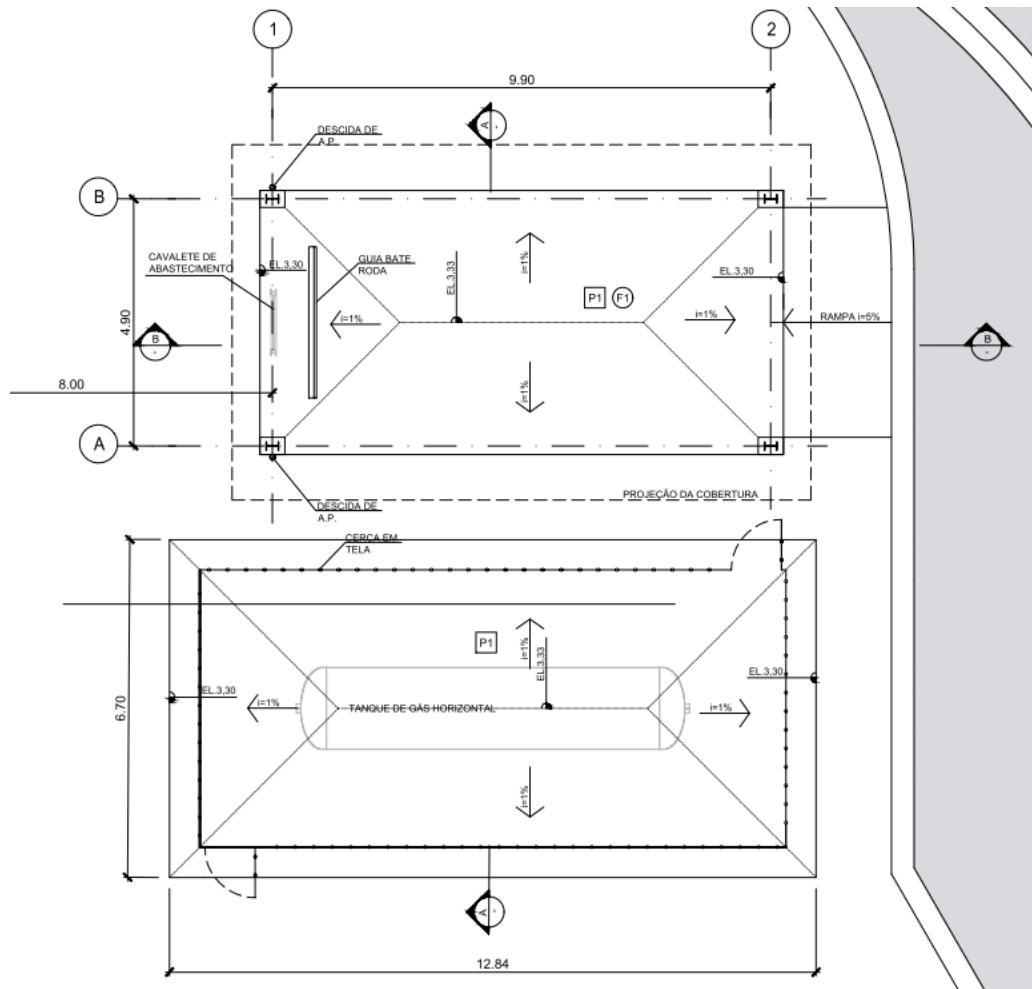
Planta do Pit Stop. Fonte: Pöyry, 2018.
